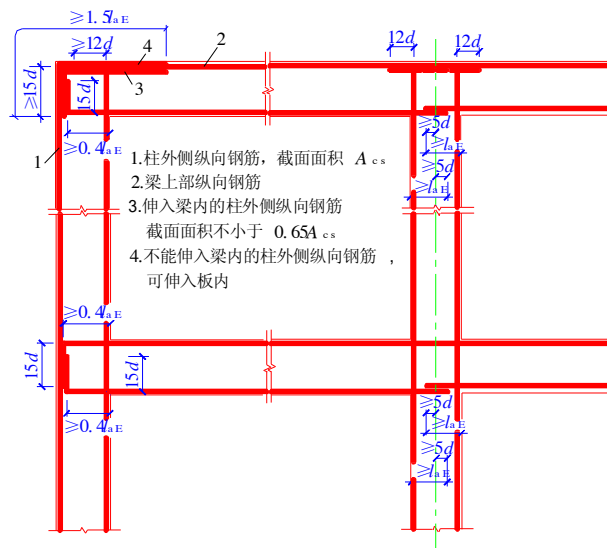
抗震设计时框架梁、柱纵向钢筋在节点区的锚固要求
